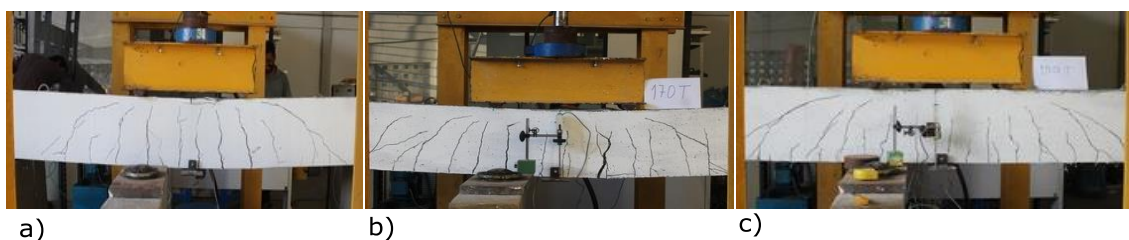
Fissuração das vigas de concreto armado: a) convencional; b) com forma F4; com forma F6.
